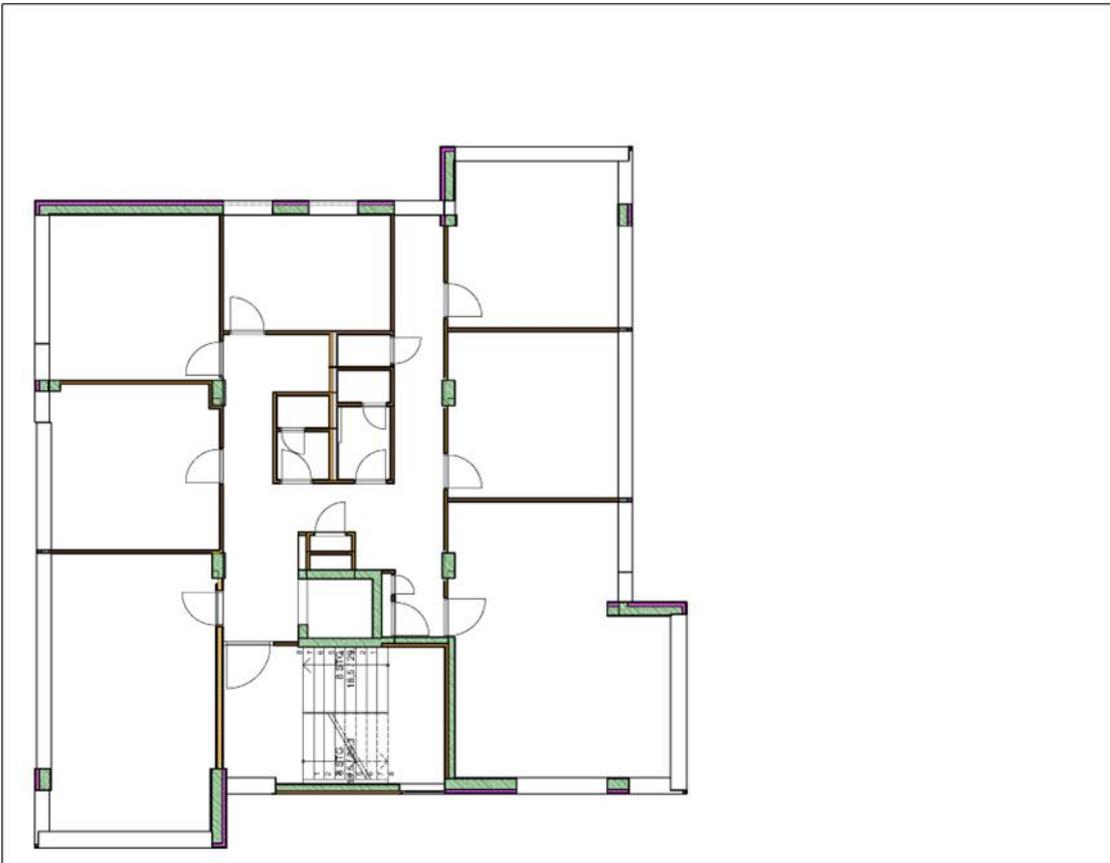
Fallbeispiel Grundriss OG4
